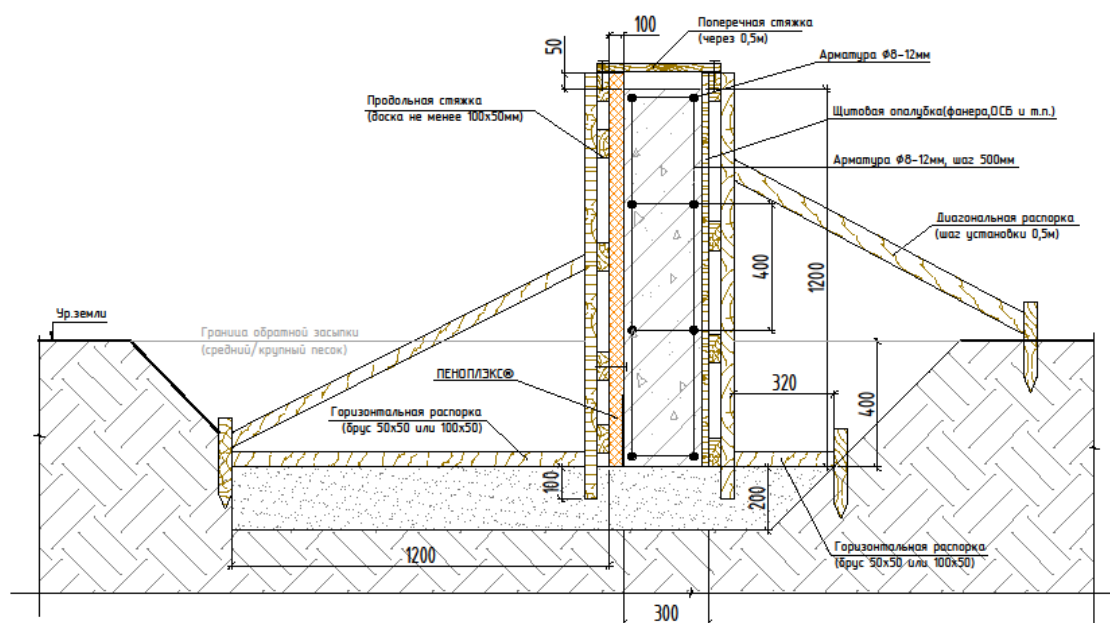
Схема устройства несъемной опалубки из плит ПЕНОПЛÉКС в процессе монтажа ленточного фундамента.
